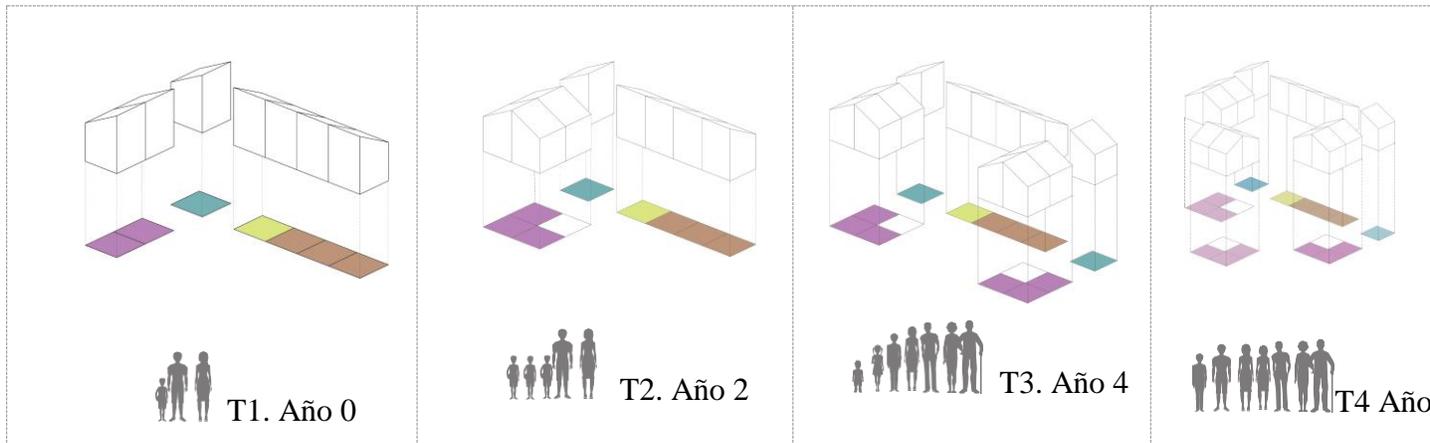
Planimetría composición 3: vivienda en U. Fuente: Autor
